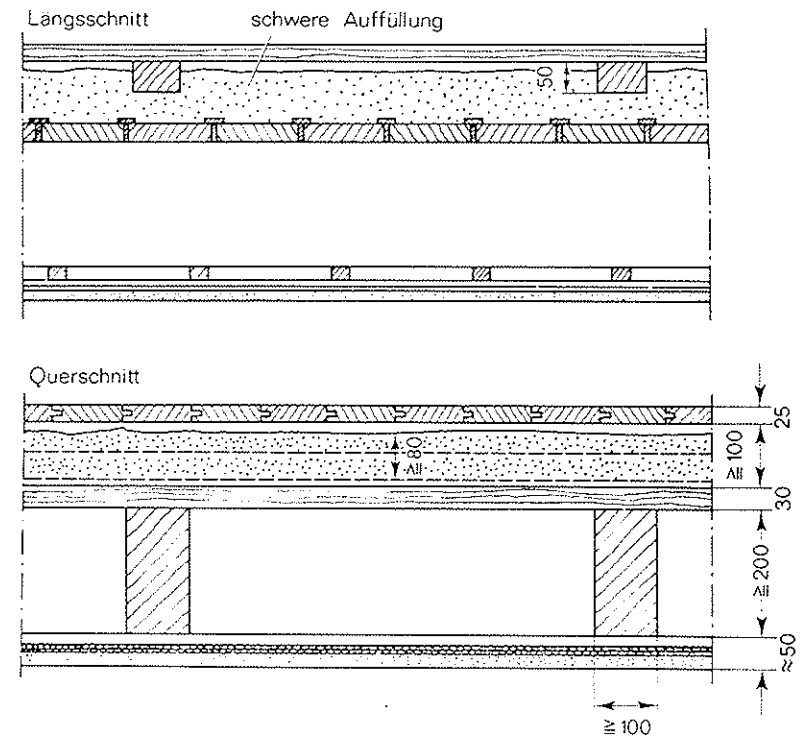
Holzbalkendecke mit ausreichendem Luft- und Trittschallschutz durch Einbettung der Lagerhölzer in die hochgelegte Sandschüttung (LSM und TSM wie bei Bild 77 und 78) (nach DIN 4109)
